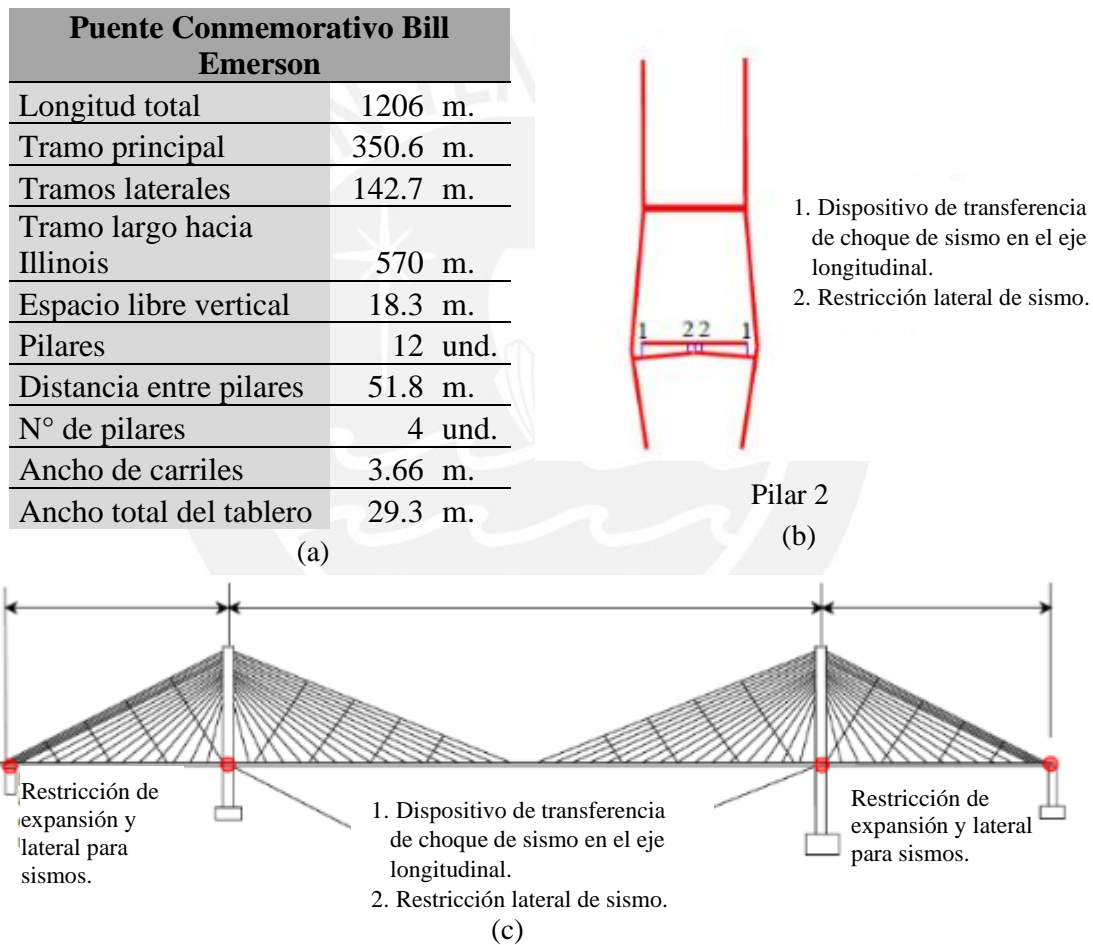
Características del puente instrumentado: (a) Dimensiones principales del puente; (b) corte transversal del pilar 2 con la ubicación de los dispositivos de control sísmico (Chen et al., 2007); y (c) corte longitudinal del tramo principal del puente con los dispositivos de control sísmico (Chen et al., 2007)
